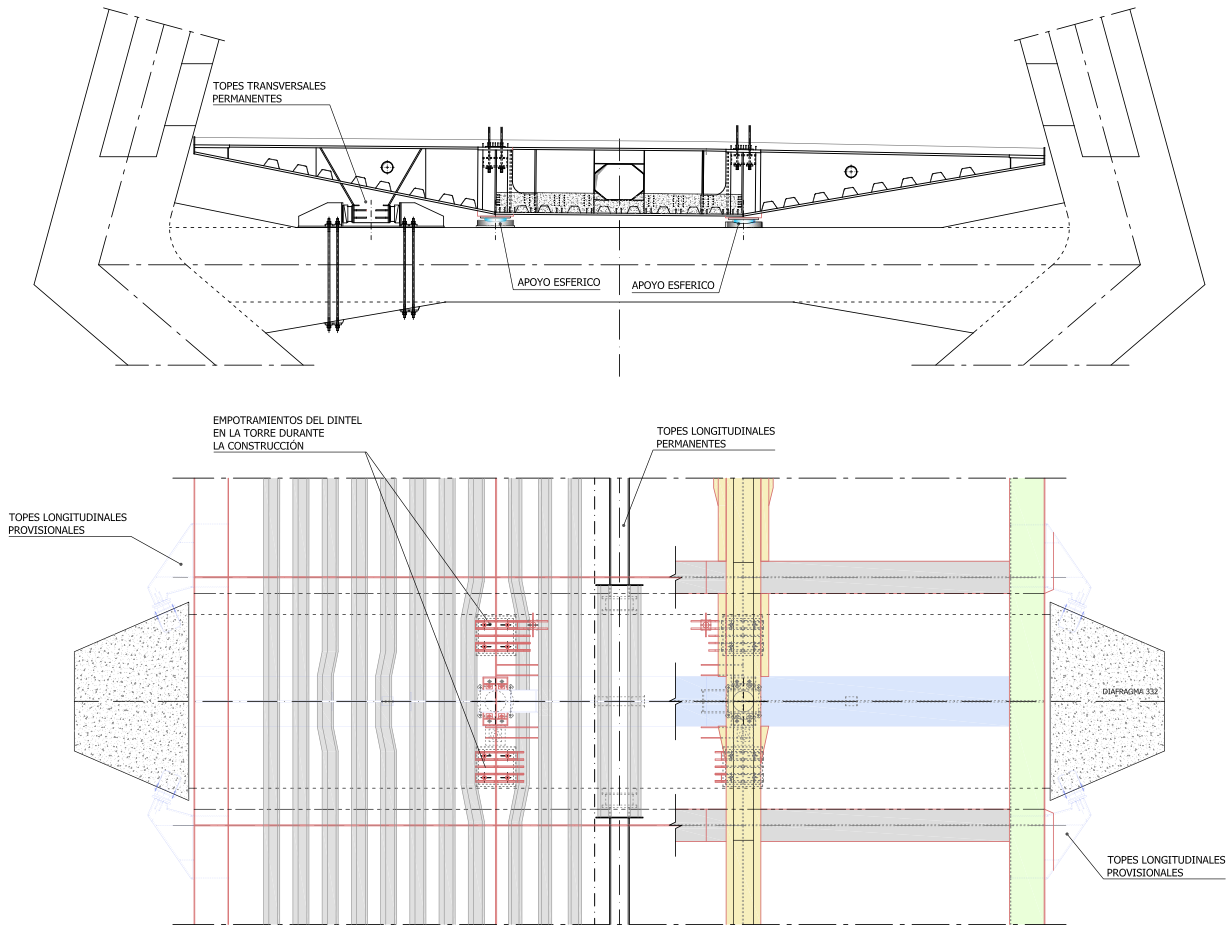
Detalles de las fijaciones provisionales y definitivas del tablero a las torres.
